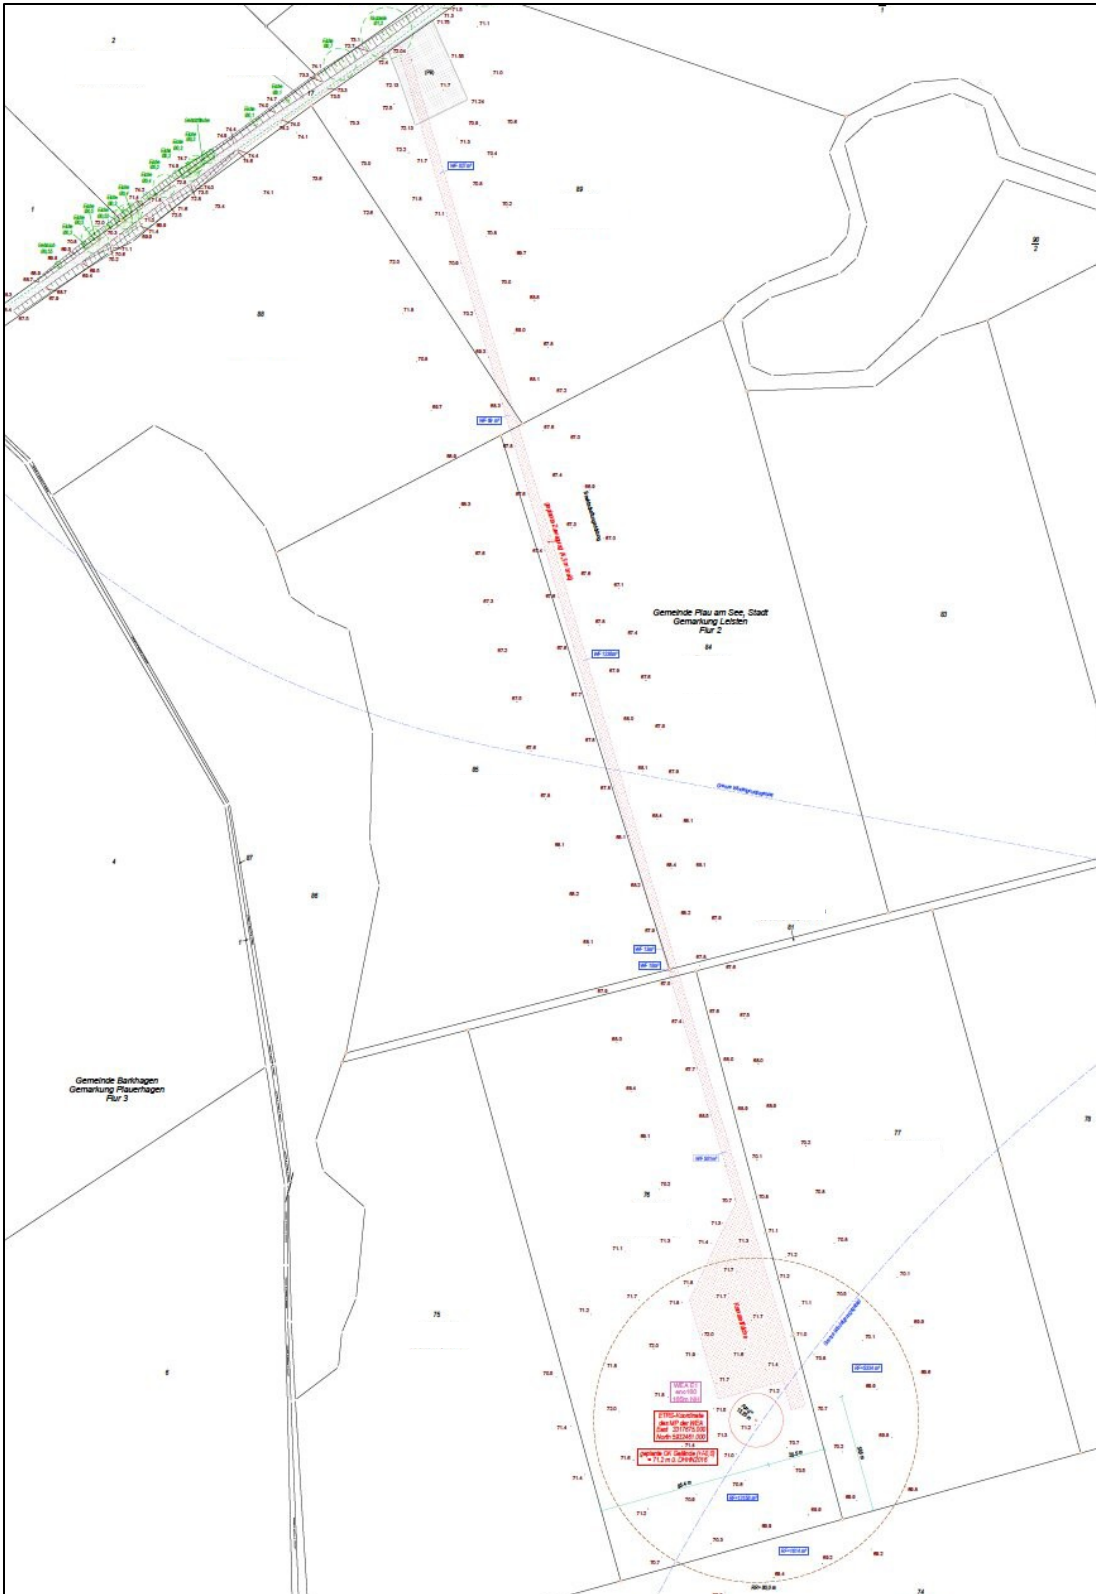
Lageplanausschnitt der WEA E1 mit Zuwegung
